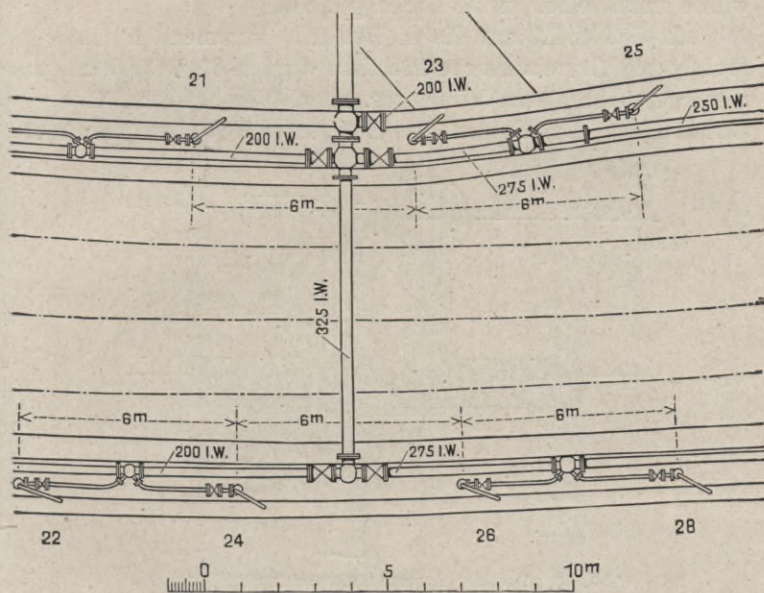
Bau der Spreeuntertunnelung in Berlin.
